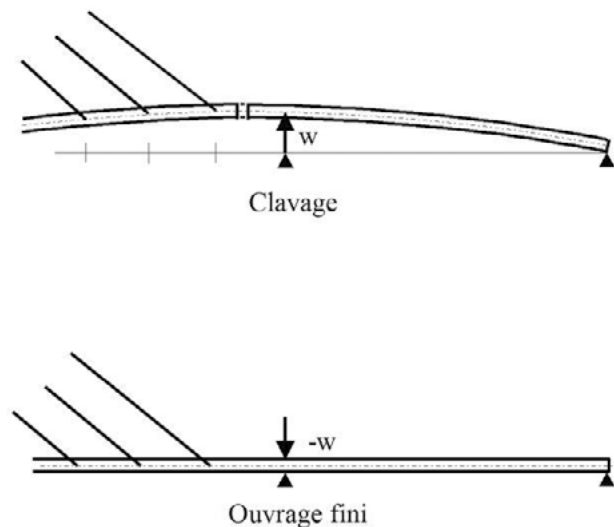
dénivellation sur la pile voisine de la travée haubanée
